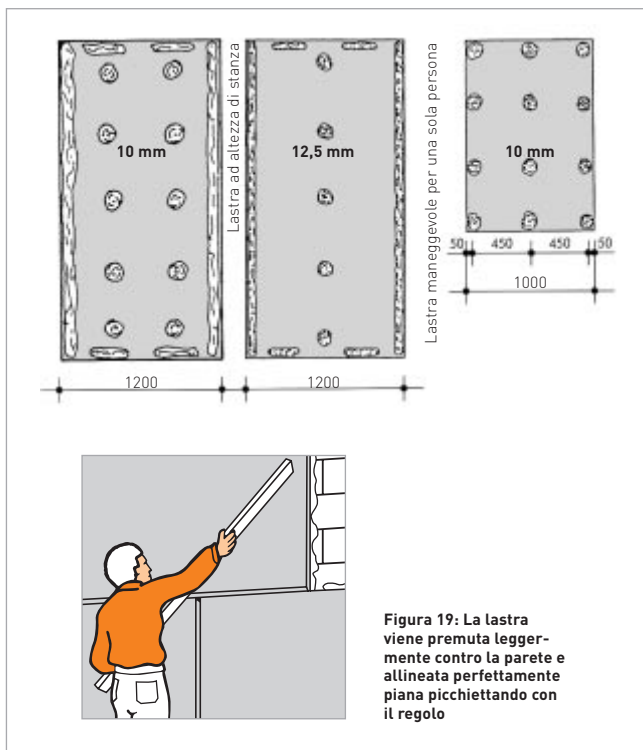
La lastra viene premuta leggermente contro la parete e allineata perfettamente piana picchiettando con il regolo
